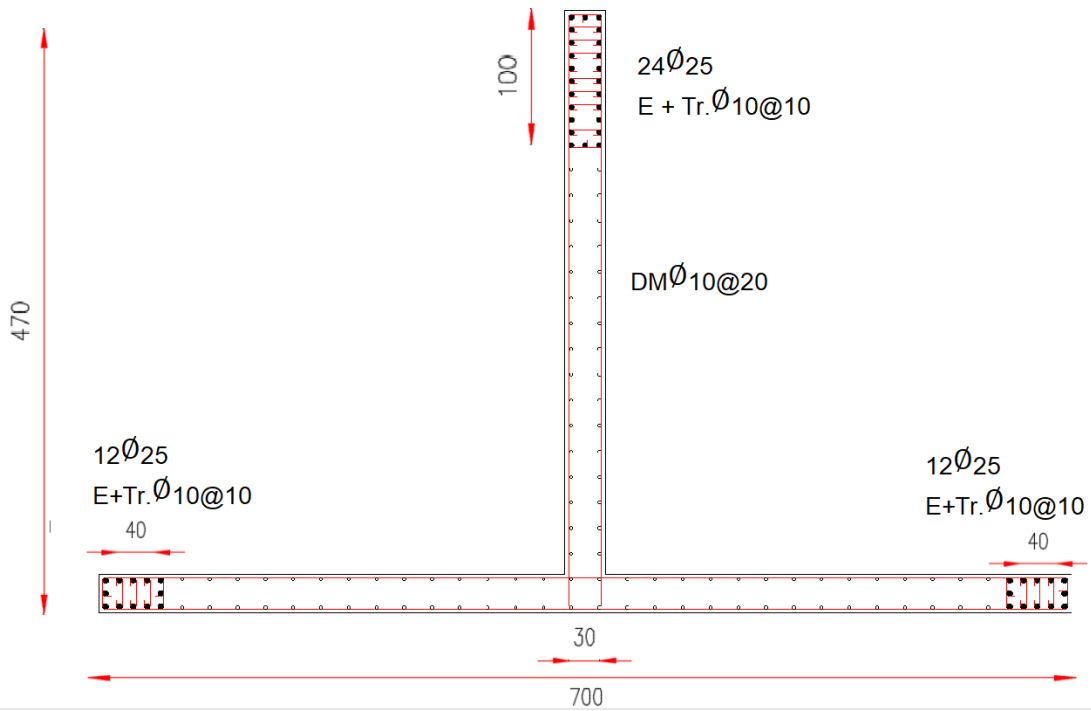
Disposición de armadura muro T modelo de 20 pisos.
